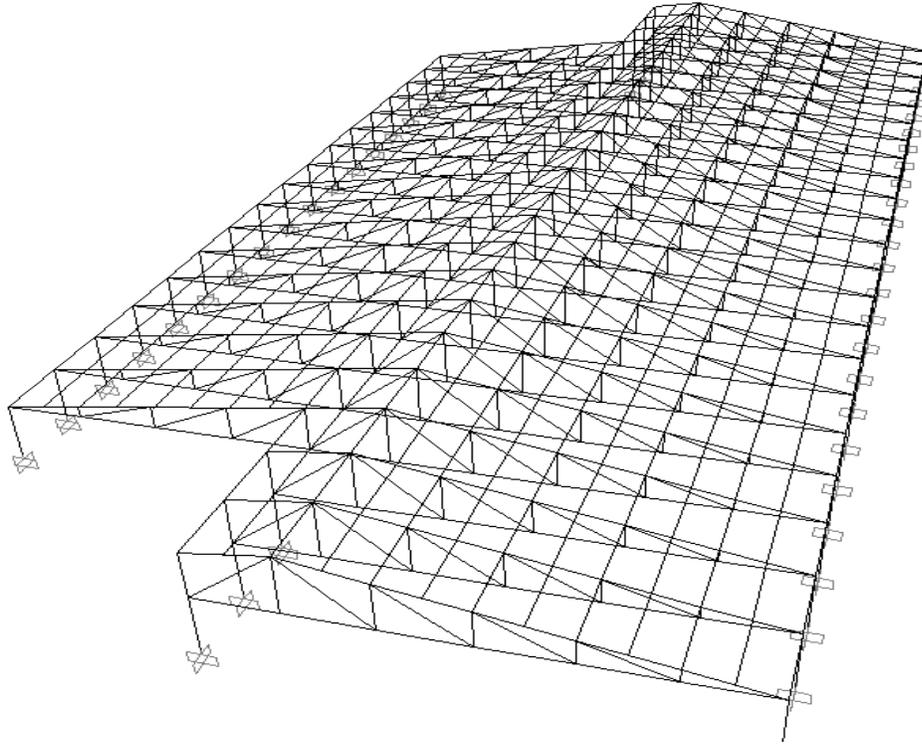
Vista de los elementos calculados trabajando en conjunto.
